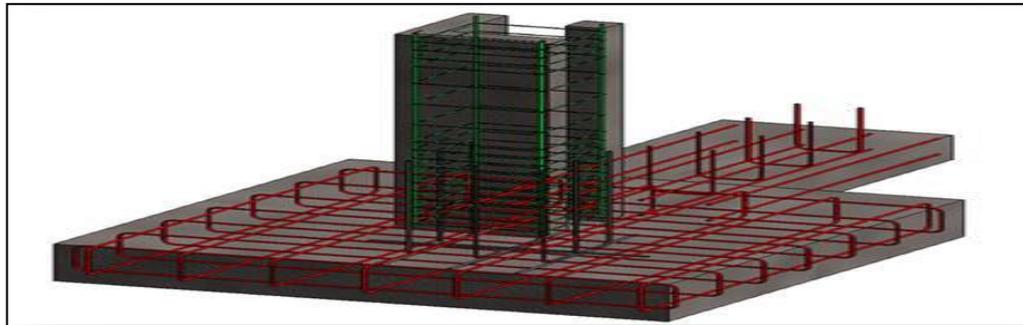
Détail d'encrage du poteau en béton armé aux fondations.
